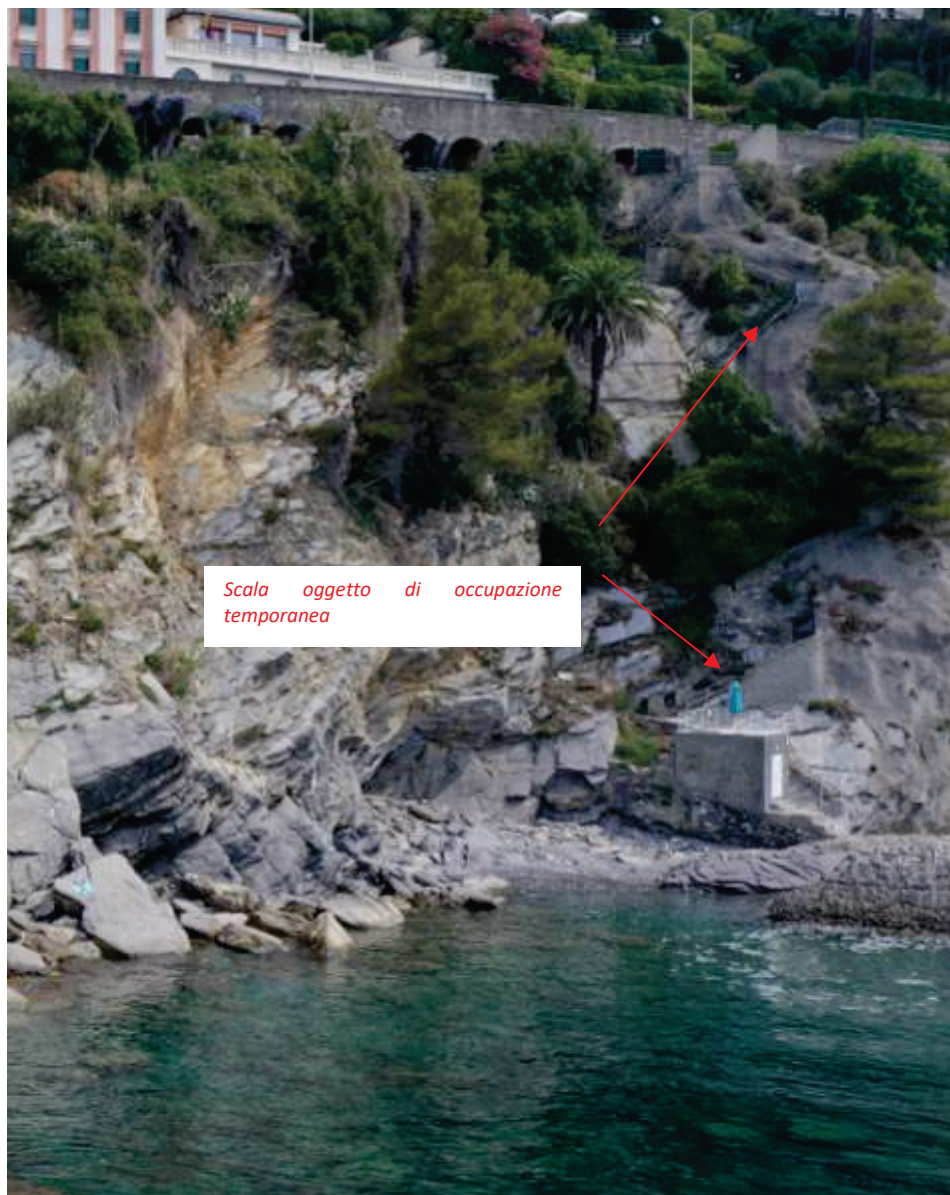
dettaglio dell'ubicazione della scala oggetto di temporanea occupazione
